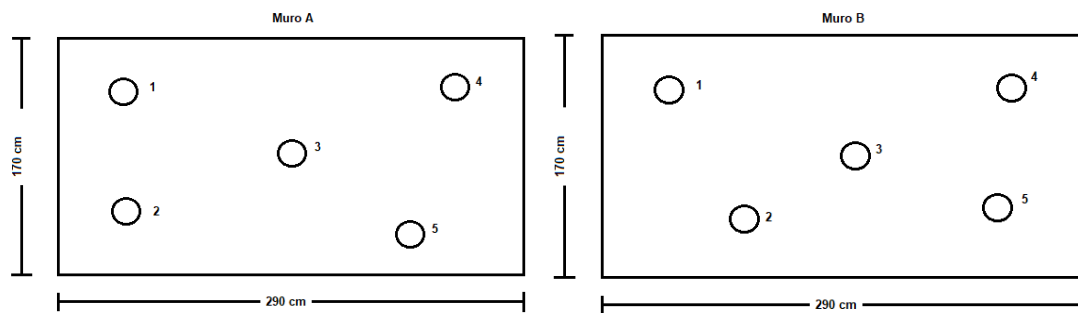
Esquema de lugar de muestreo en muros de hormigón armado para permeabilidad al aire, Facultad de Arquitectura, Universidad de Valparaíso Chile.
